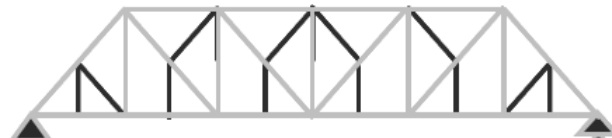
Jembatan Rangka Tipe *Non Parallel Chord (Parker Truss)
